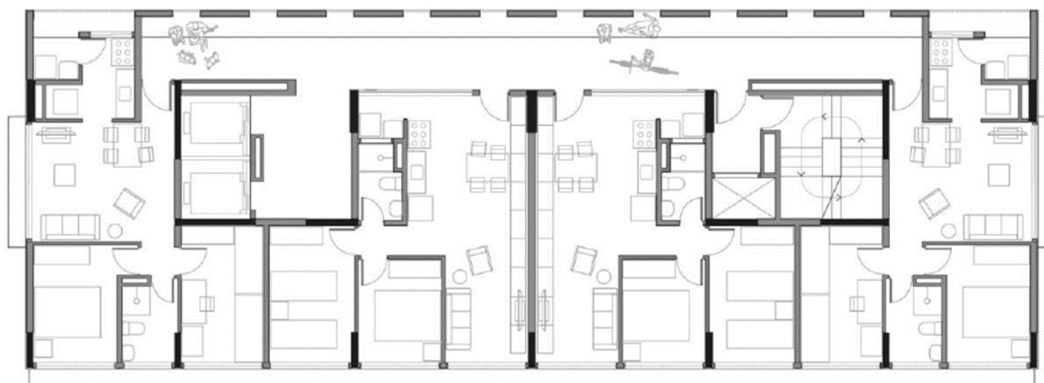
Planta de um dos blocos do Conjunto Habitacional Jardim Edite – São Paulo
